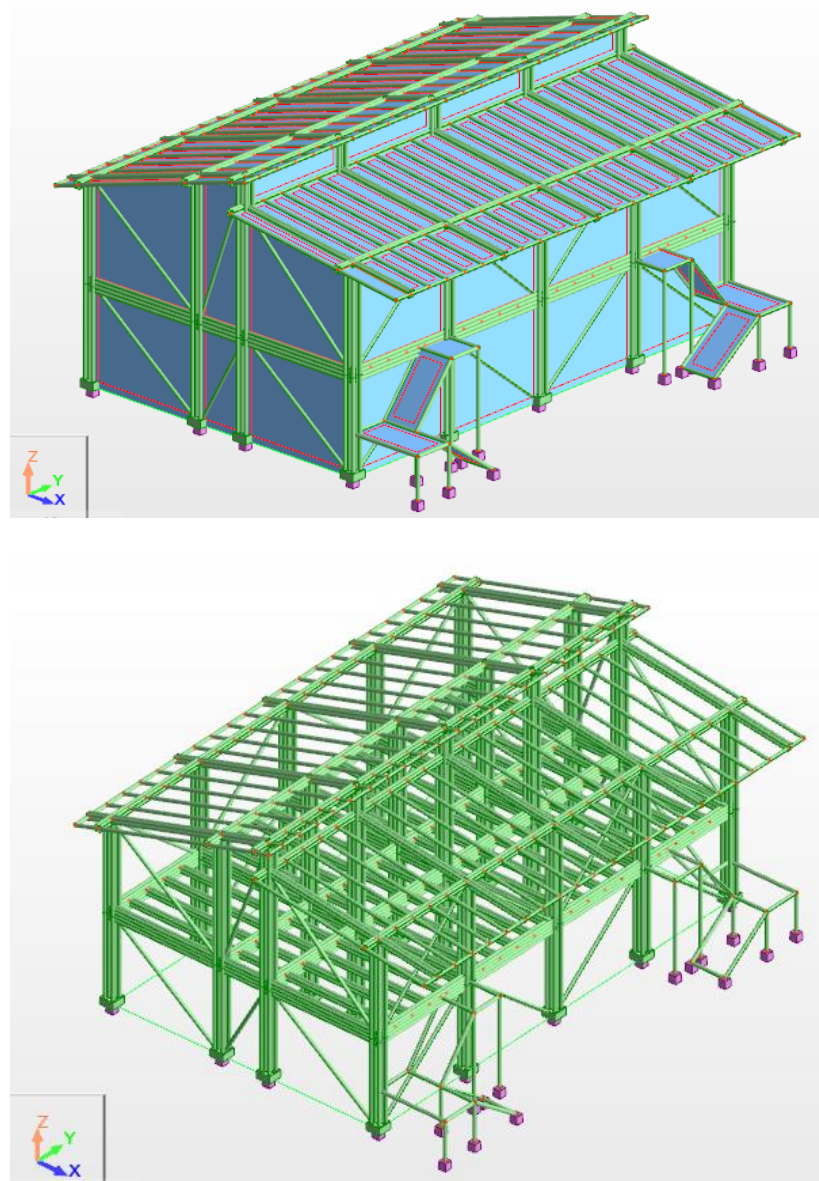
Diseño definitivo del sistema constructivo mixto (caña guadúa y materiales convencionales). Vista isométrica.
